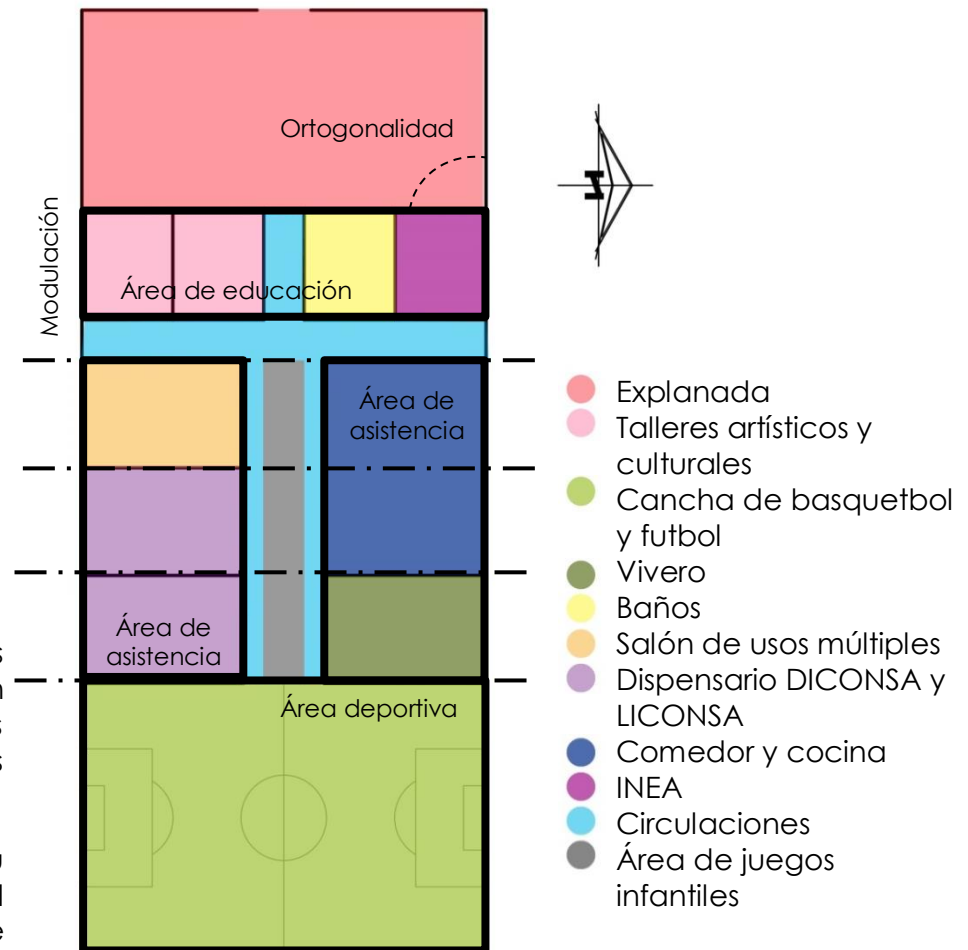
Planta baja centro comunitario Gertrudis Schz.
